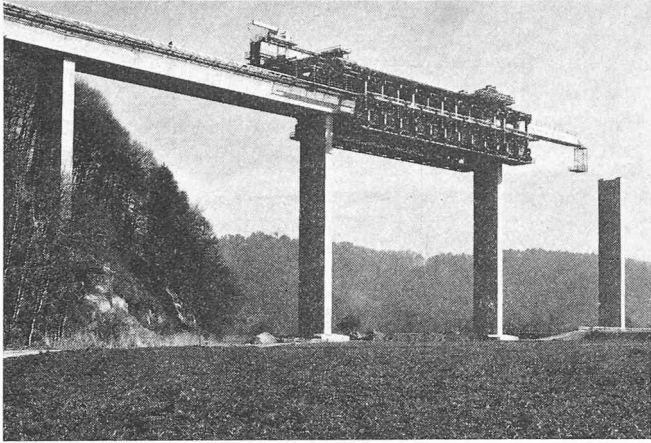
Das Gerüst für feldweisen Vorbau steht in Feld 3 bereit zur Vorfahrt ins nächste Feld, aufgelagert auf bereits betoniertem Kastenträger über dem 2. Pfeiler v. l., 12 m davor und auf dem nächsten Pfeiler
